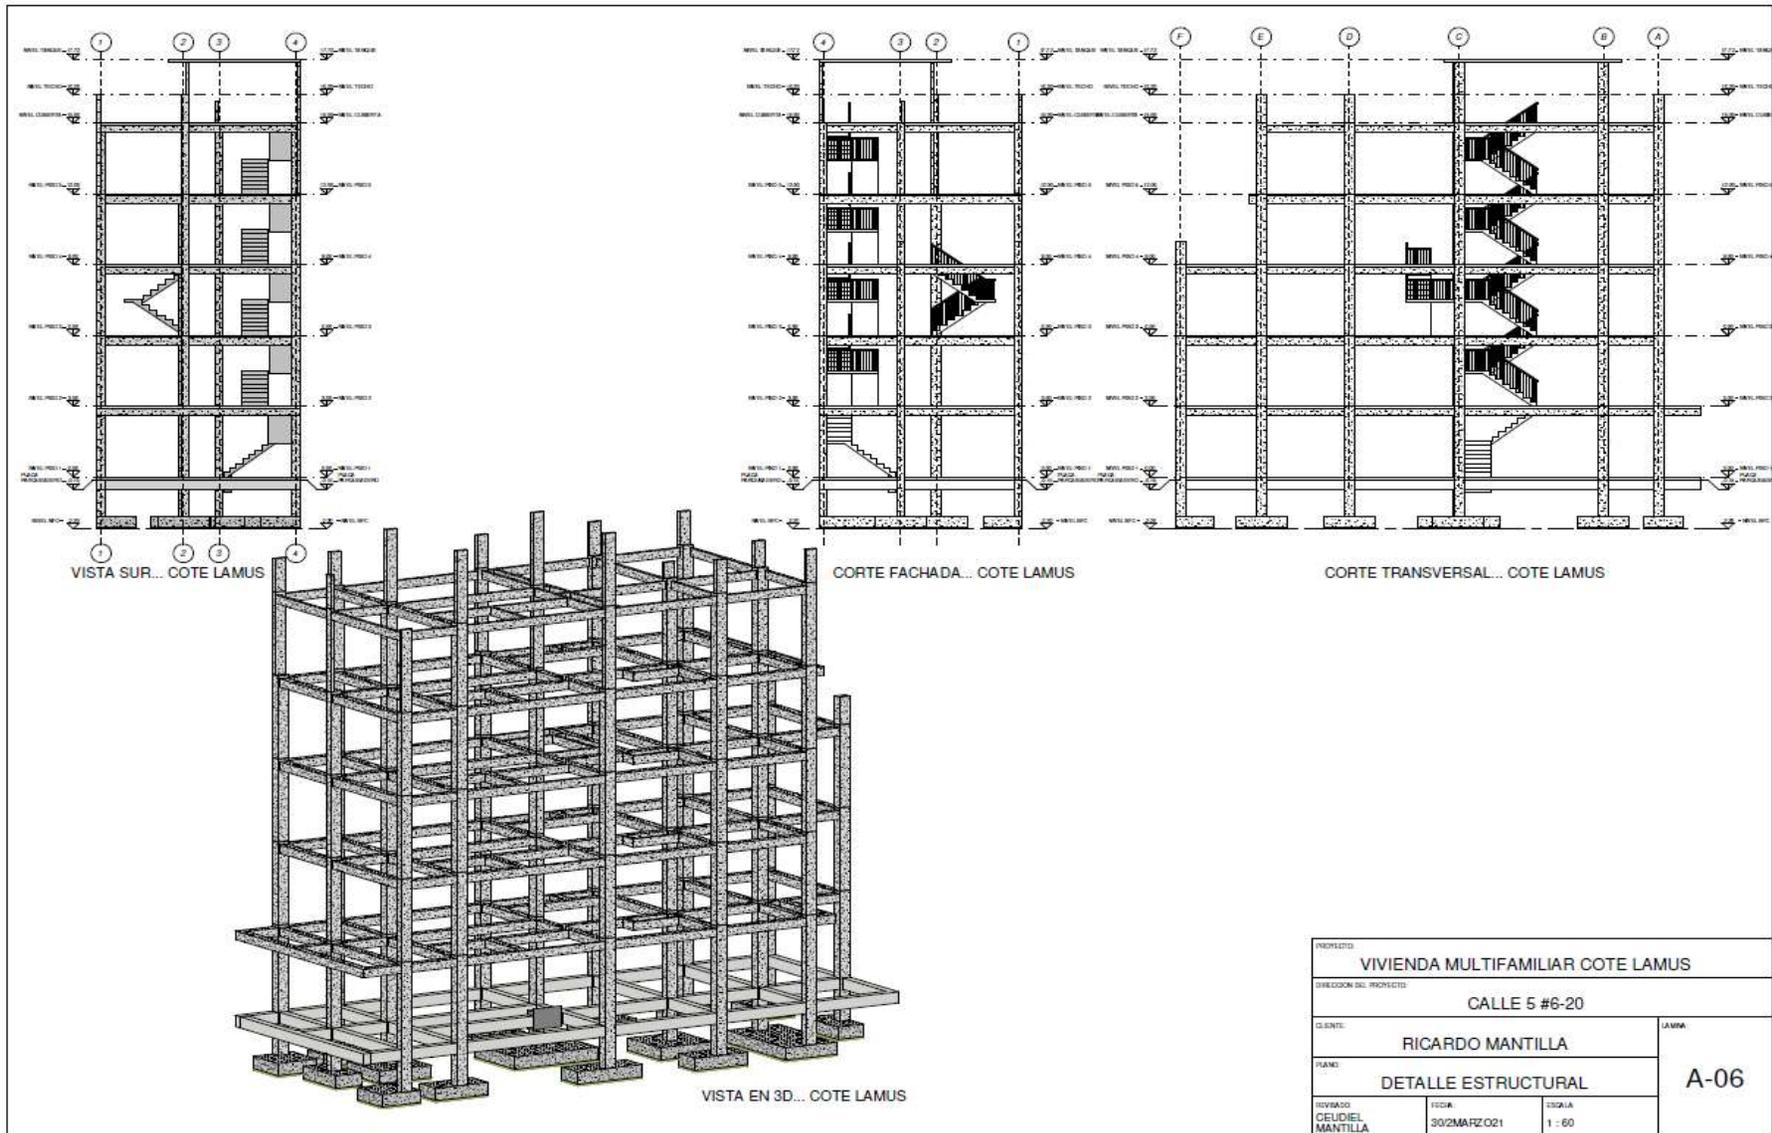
Detalle estructural Cote lamus. Diseño: Revit 2021
